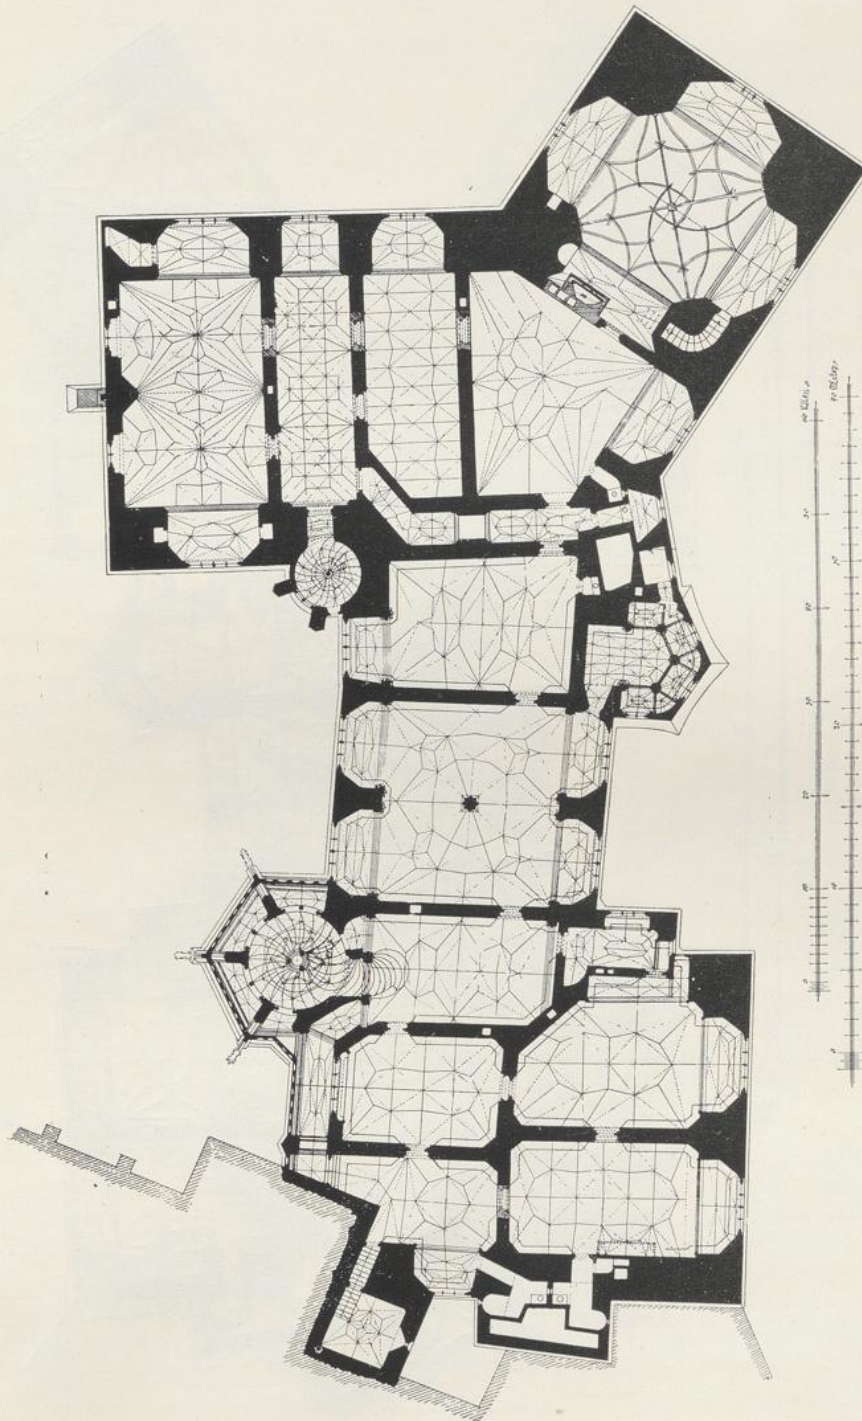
b. Albrechtsburg zu Meißen. Grundriß des ersten Obergeschosses.
